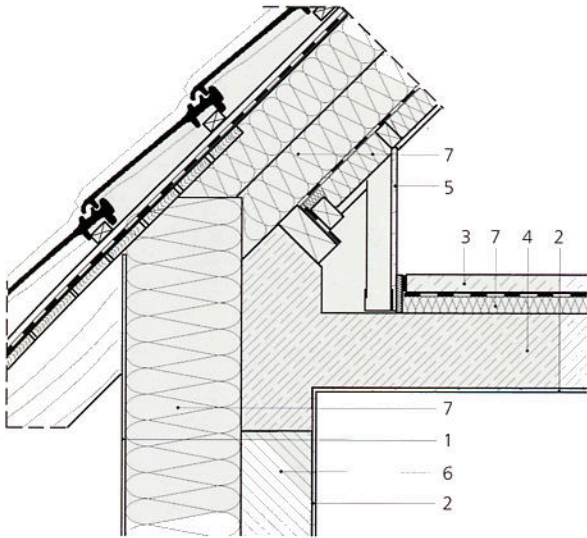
Détail de construction : coupe d'un avant-toit et d'un débord du toit (toit élevé)
